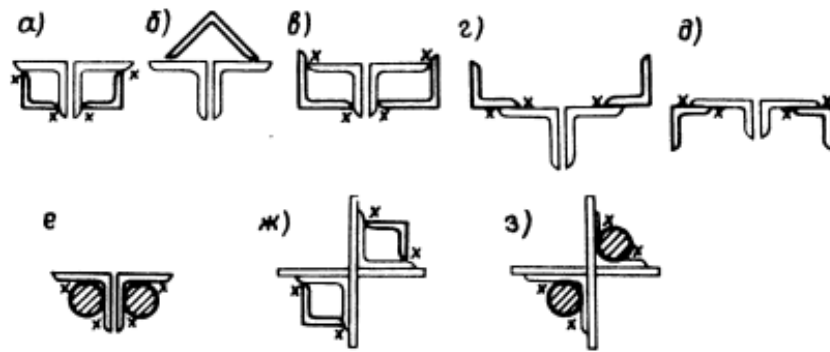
Различные схемы усиления прямых уголковых стержней фермы
